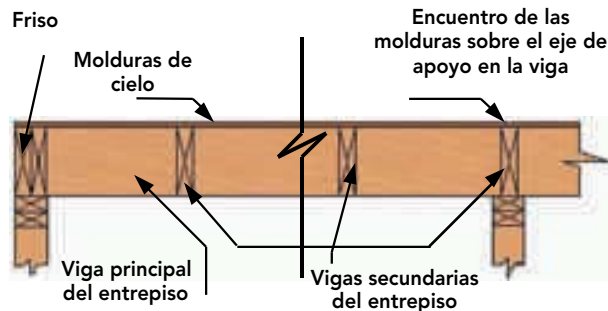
Corte de entrapiso que muestra las molduras apoyadas y fijadas sobre el envigado, quedando las vigas a la vista. Sobre éstas se debe considerar la base para la solución de pavimento y aislación acústica.
